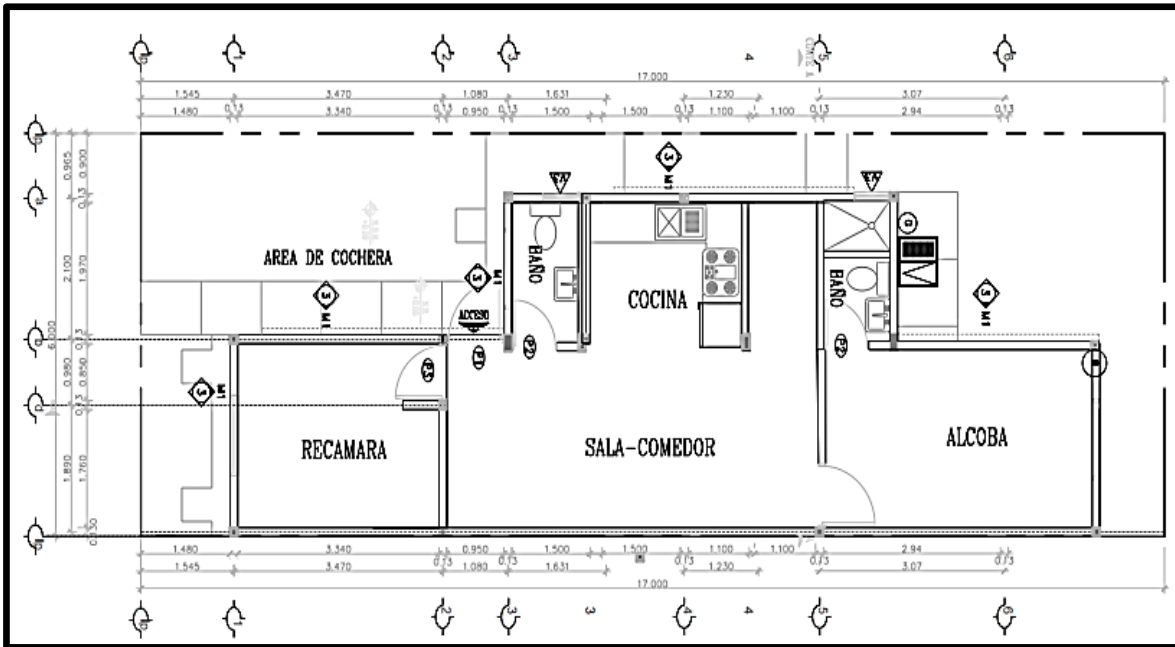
Vivienda de interés social tipo económica, planta arquitectónica
